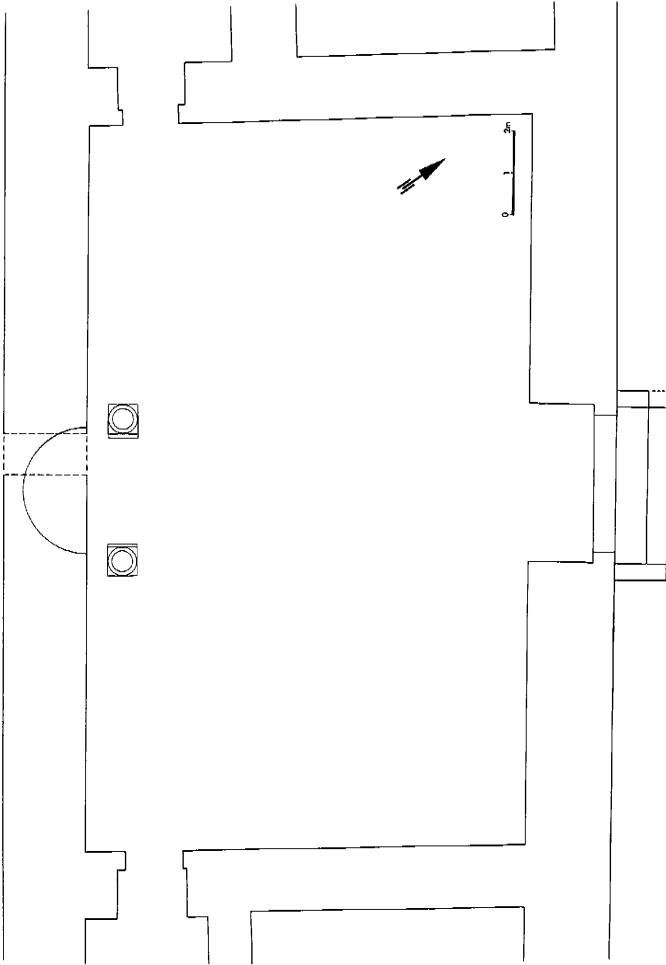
Kaiserkuiltraum im Ammontempel von Luxor. Grundriss (nach Deckers)
